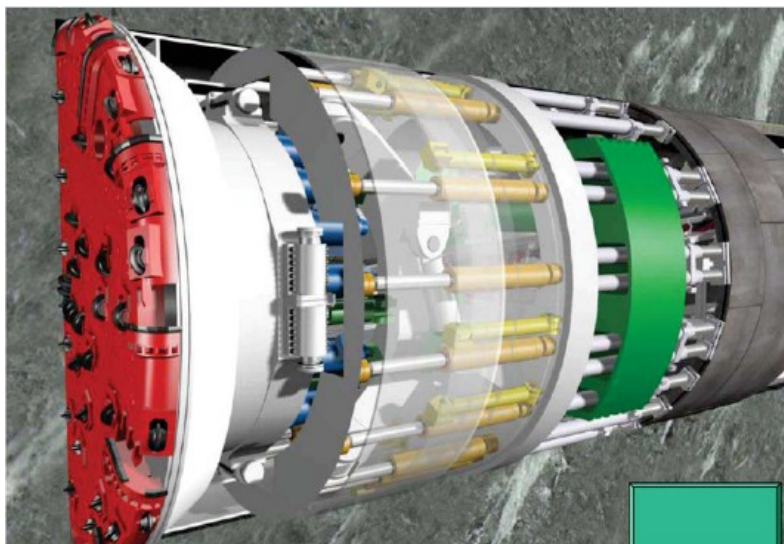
Creusement au tunnelier (Tunnel Boring Machine TBM)
